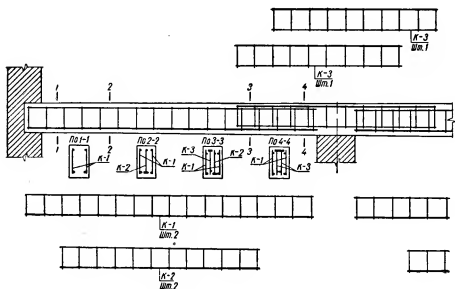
93. Схема армирования отдельных многопролетных балок.
